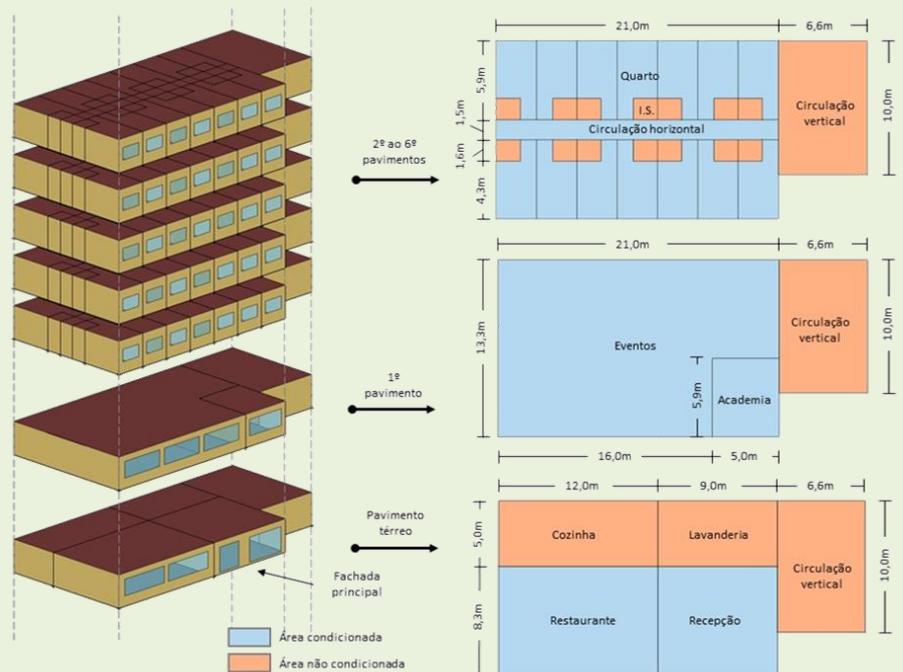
Planta dos pavimentos – área total de 2.417 m<sup>2</sup>
